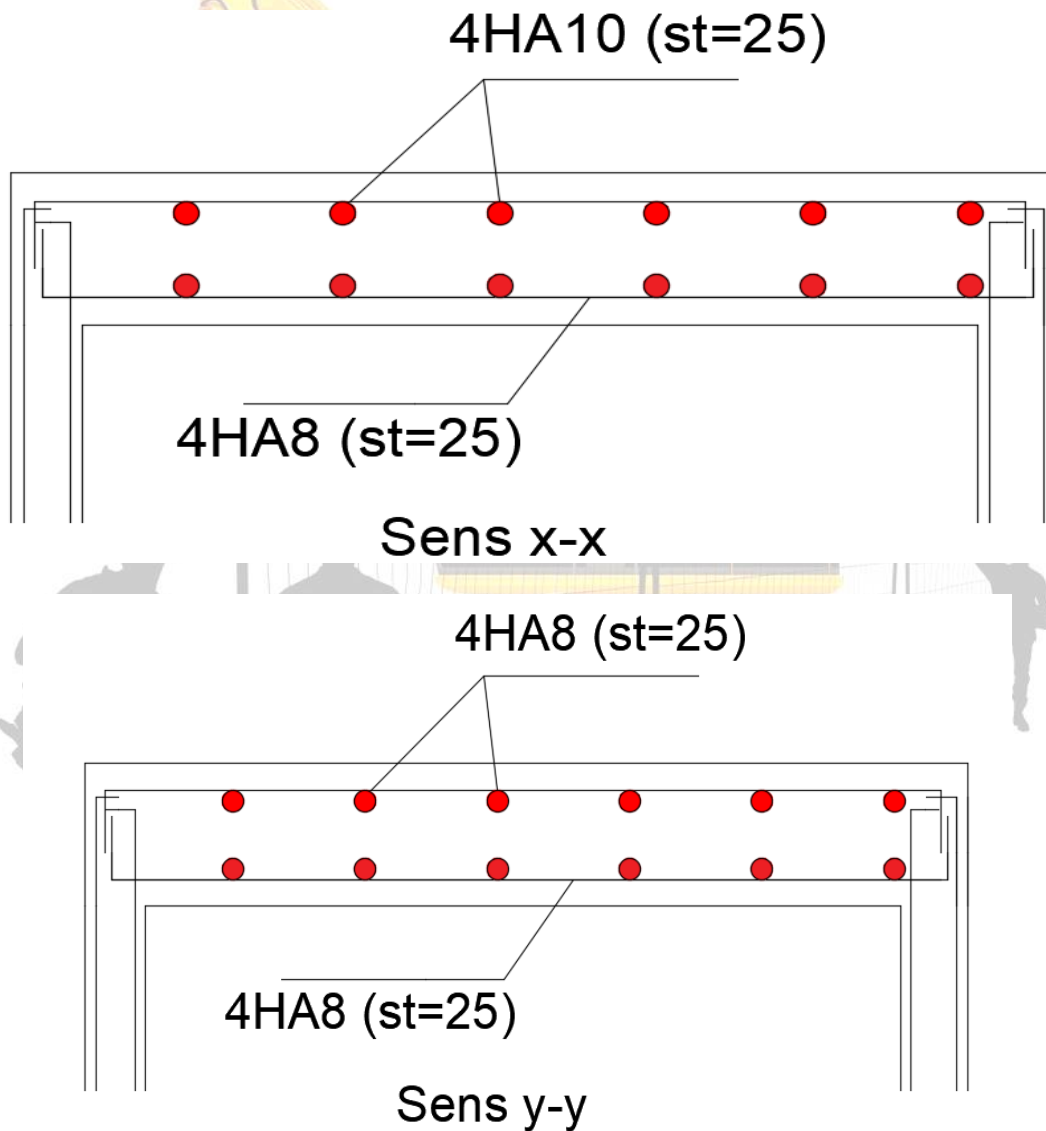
Plan de ferrailage de la dalle salle machine.
